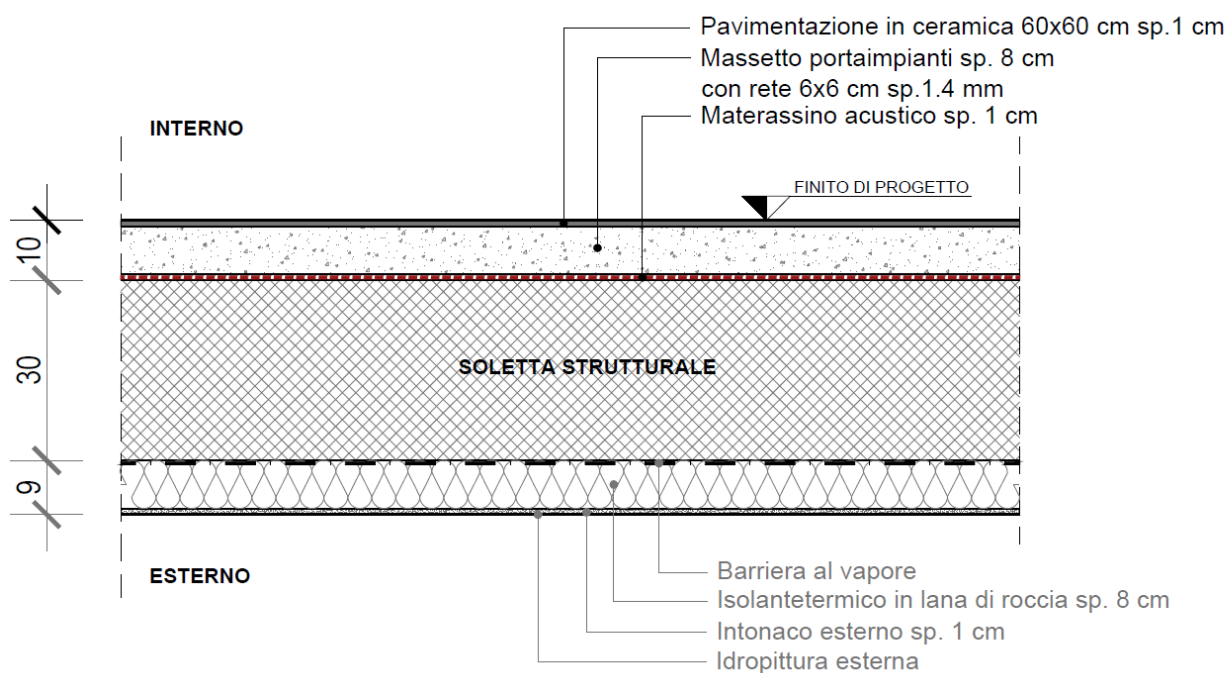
dettaglio della porzione di solaio esterno in aggetto
